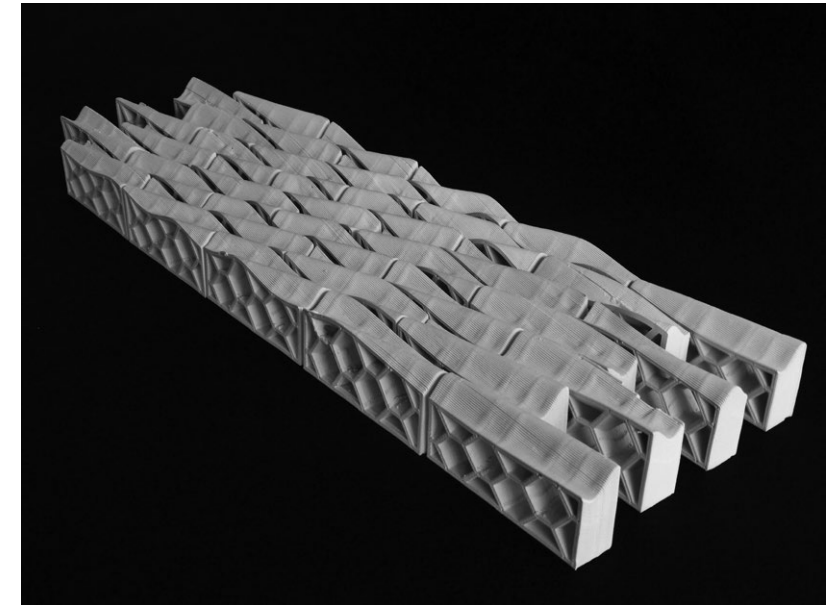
Wave Wall, projeto de fabricação aditiva em cerâmica do ACLab
